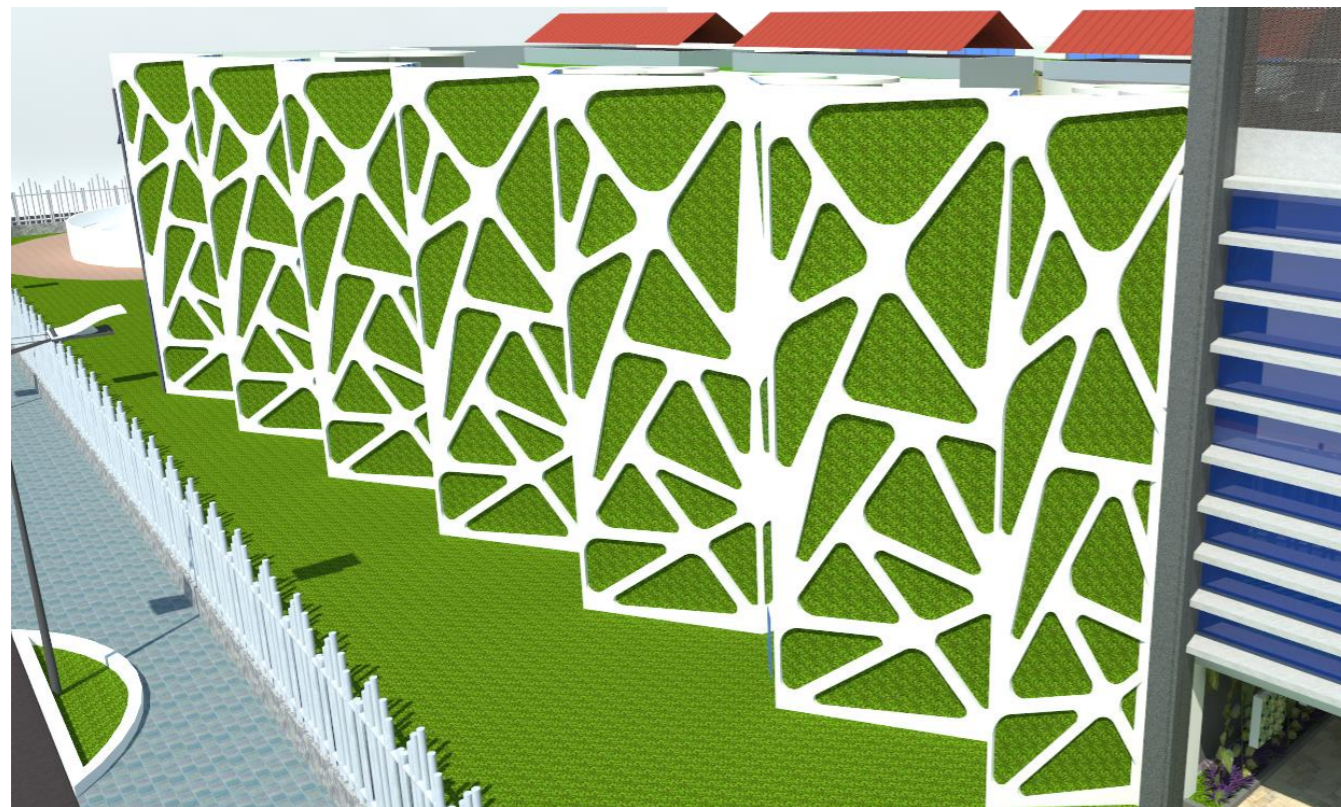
Detalle Muro Verde. (Canevaflor, 2009-2016)
